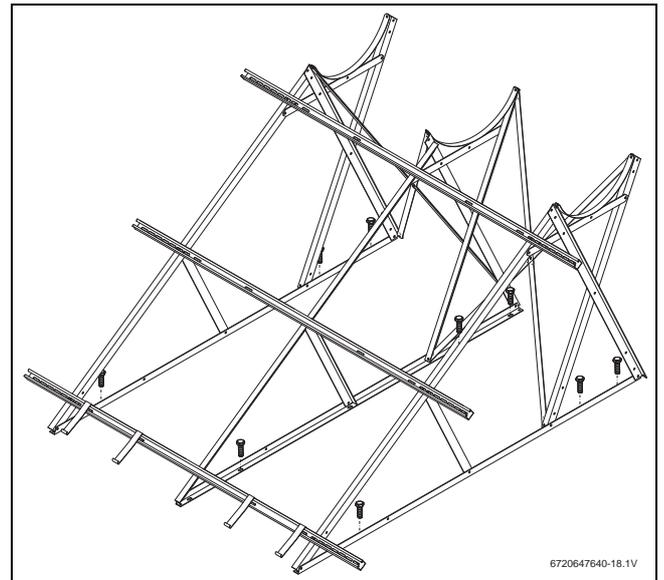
Estrutura para telhado plano fixa diretamente na cobertura (aqui, no sistema de 300 I)
